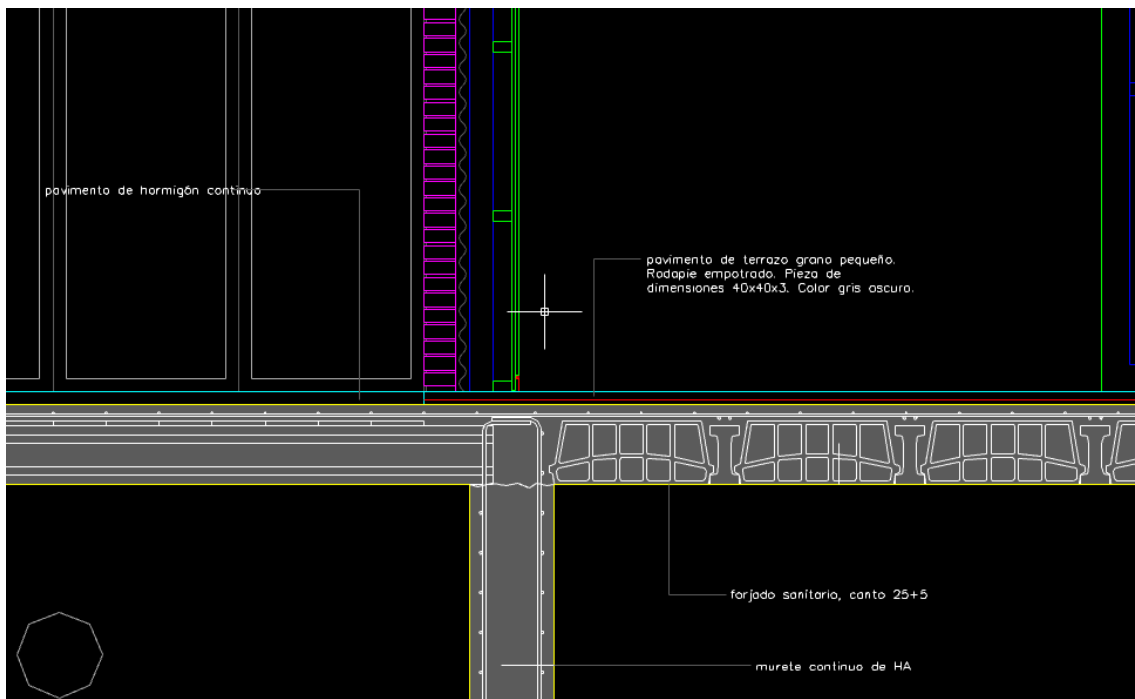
Dos tipos de pavimento en planta baja. (Obtenida del plano de secciones del proyecto de ejecución).
